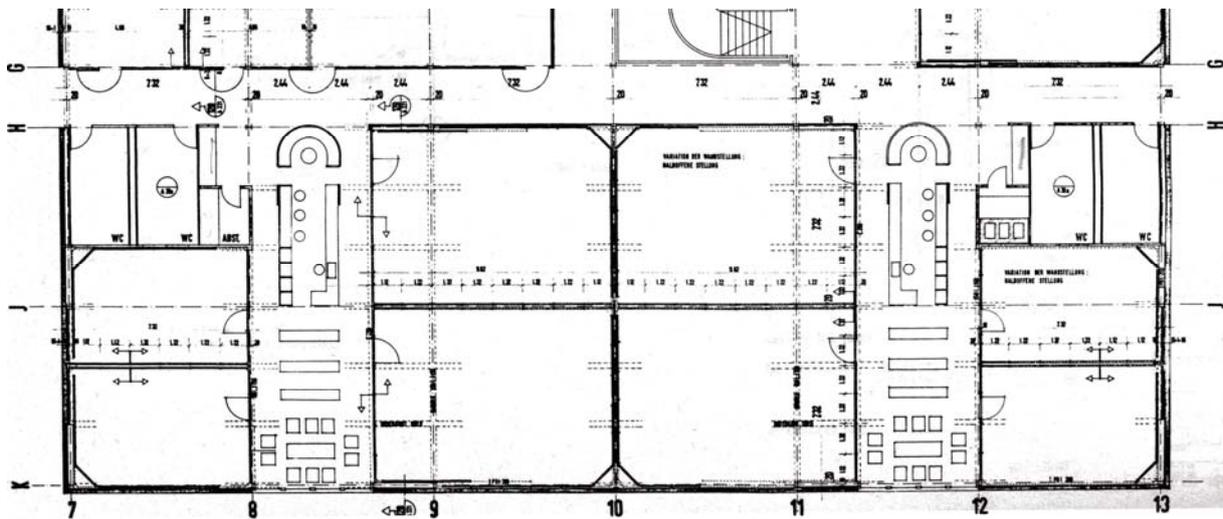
Teilausschnitt des Grundrisses mit dem Titel: *Übersichtsplan Schiebewände* rund um zwei ‚Servicestationen‘³³
